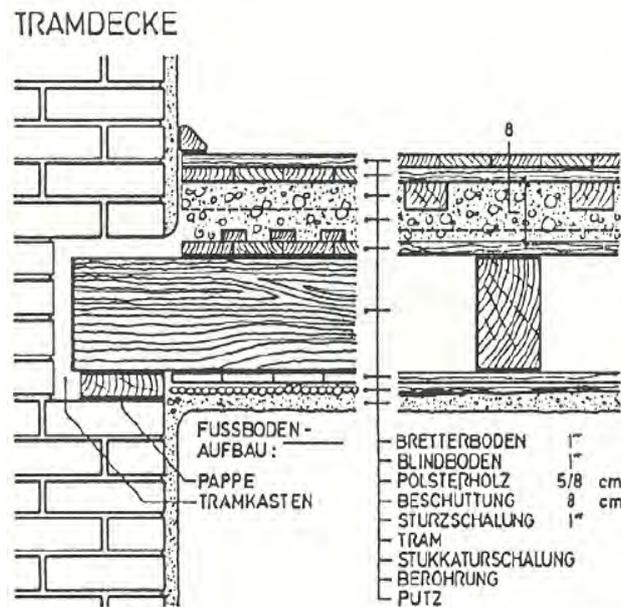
Detail Tramdeckenkonstruktion⁷
